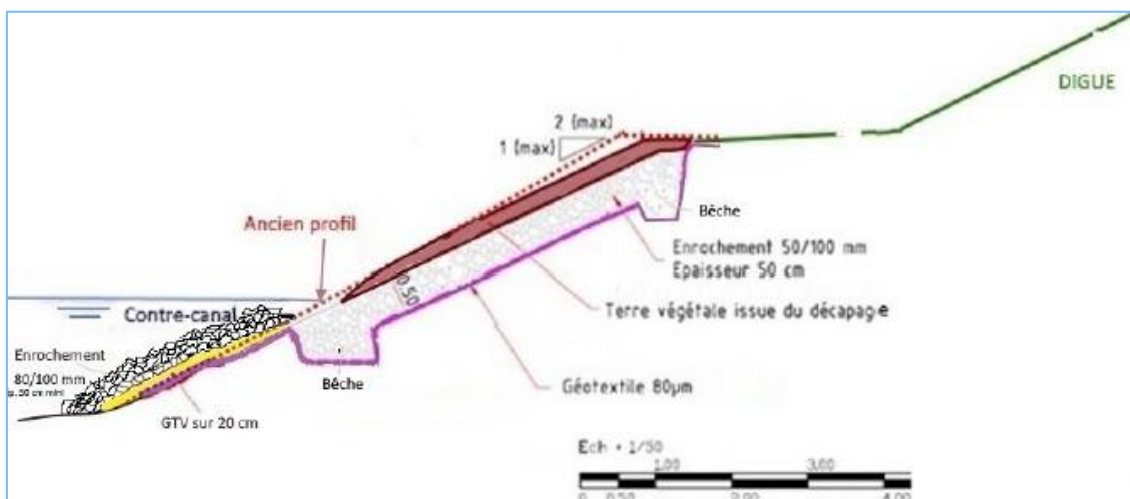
Coupe type de la recharge sur le talus du canal de drainage
